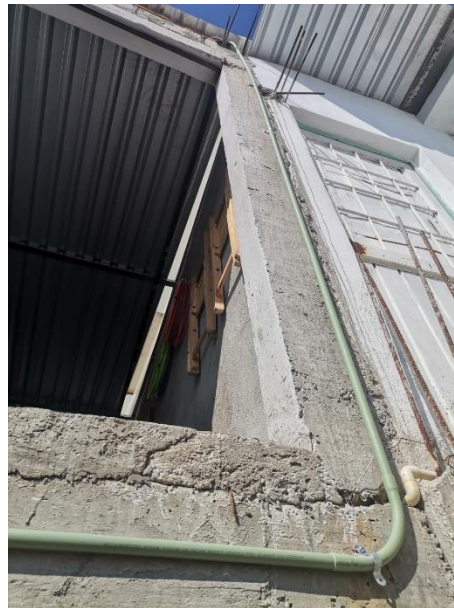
Tubo conduit instalado a lo alto de la pared exterior del taller.
